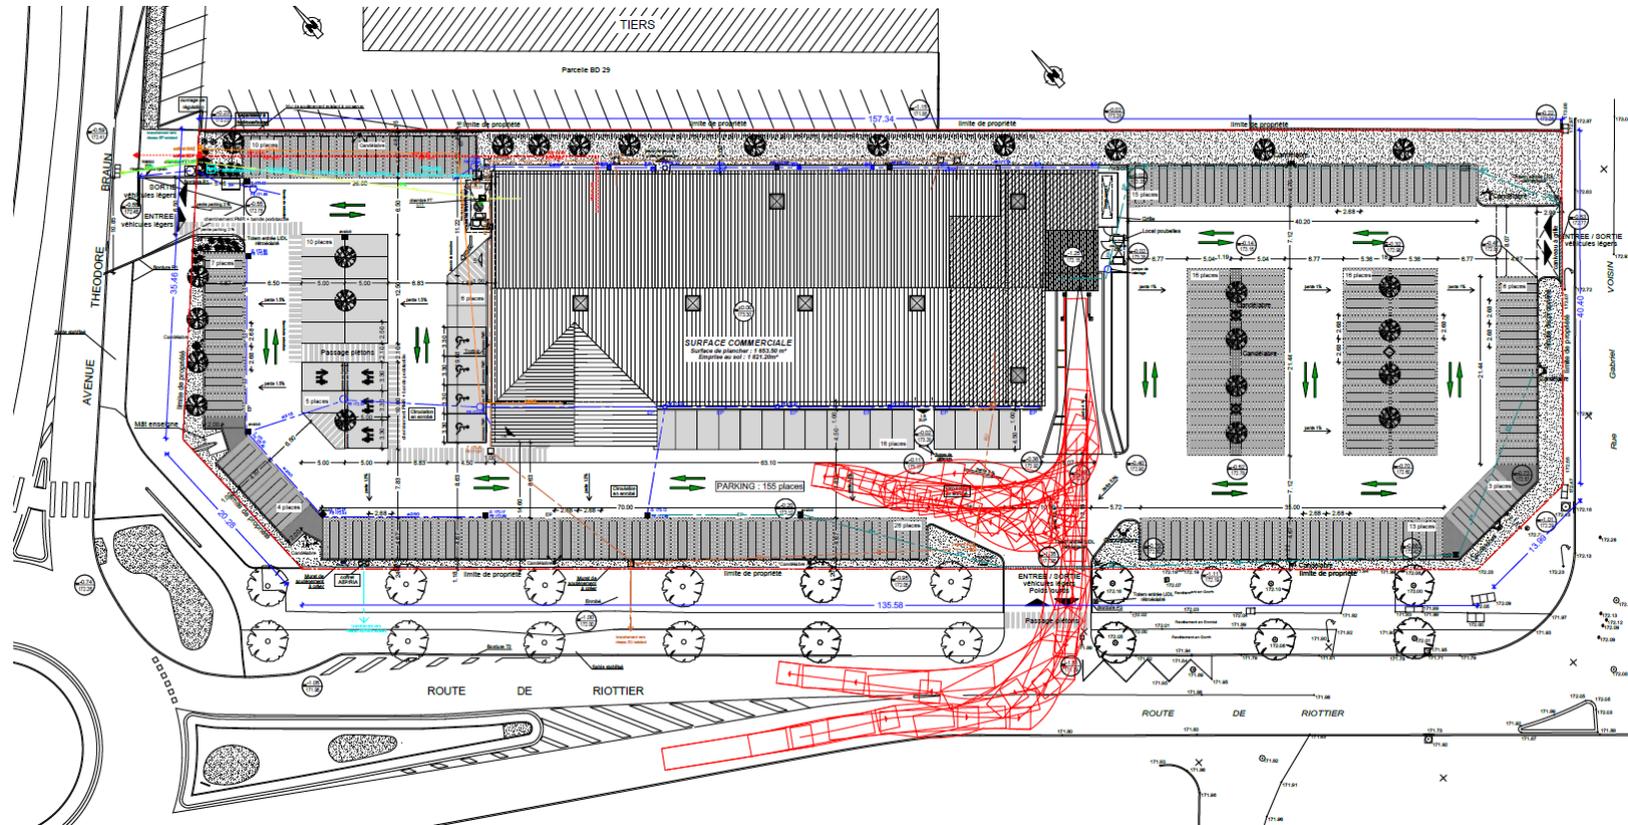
Plan masse du projet (Source : Cabinet d'Architecte Jean-Christophe LARDEAU)
